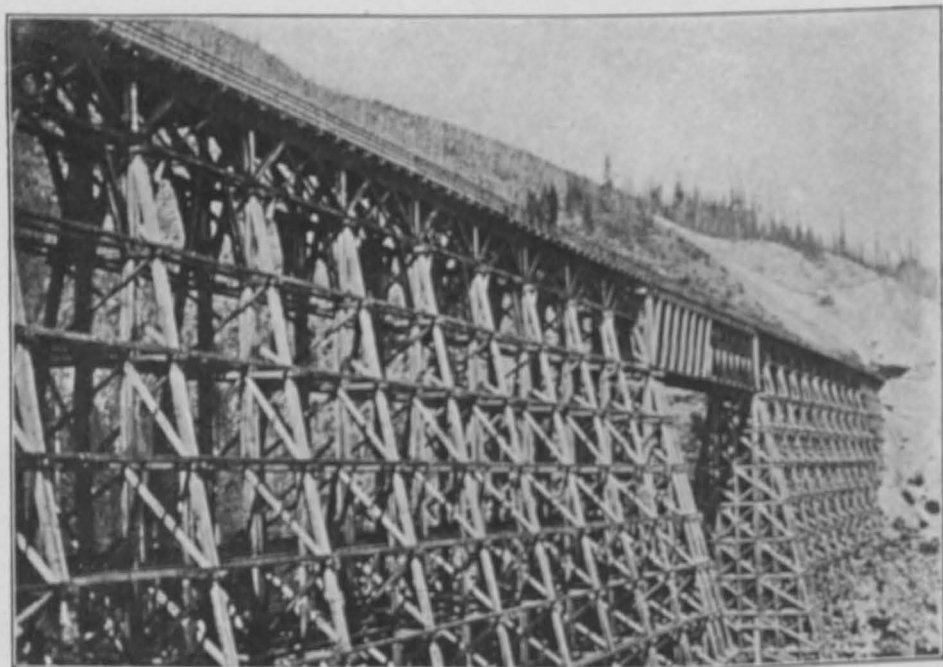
Gerüstpfeilerbau (Trestlework) auf der Central-Pacificbahn. 1869.
